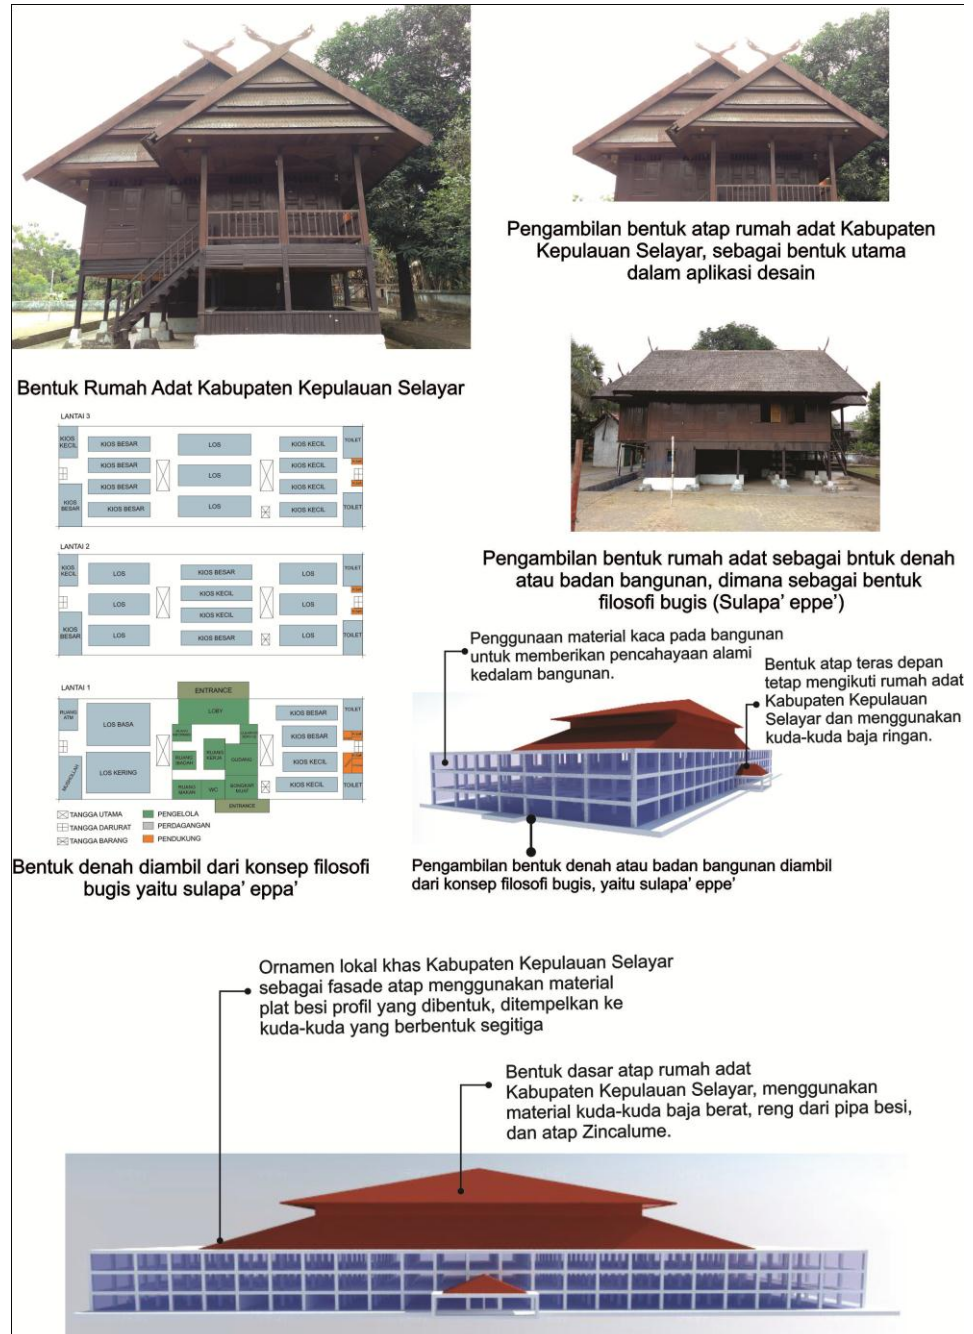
Pengolahan Bentuk Alternatif 1
